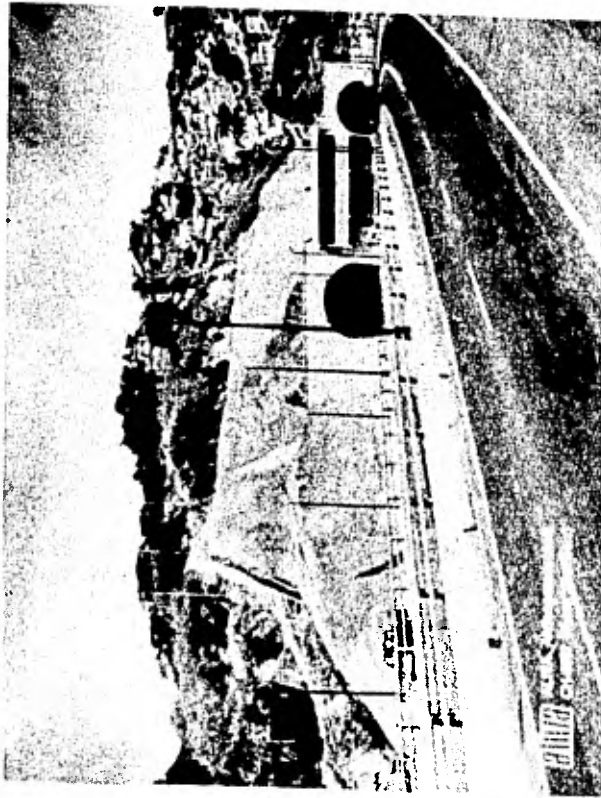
Estabilización de un talud a la entrada de dos túneles carreteros.
